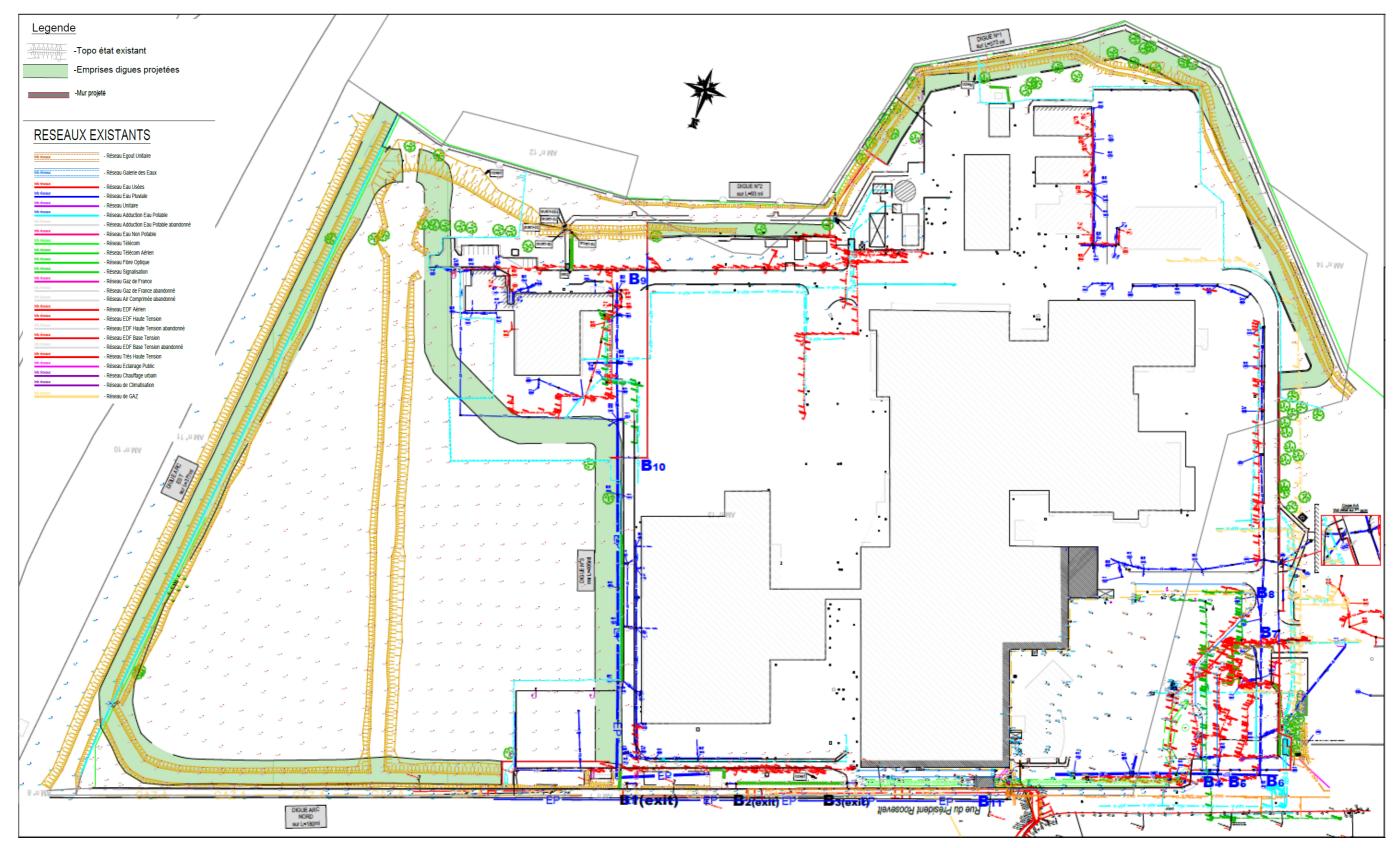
Plans des réseaux existants sur le site de SANOFI et la RD66
